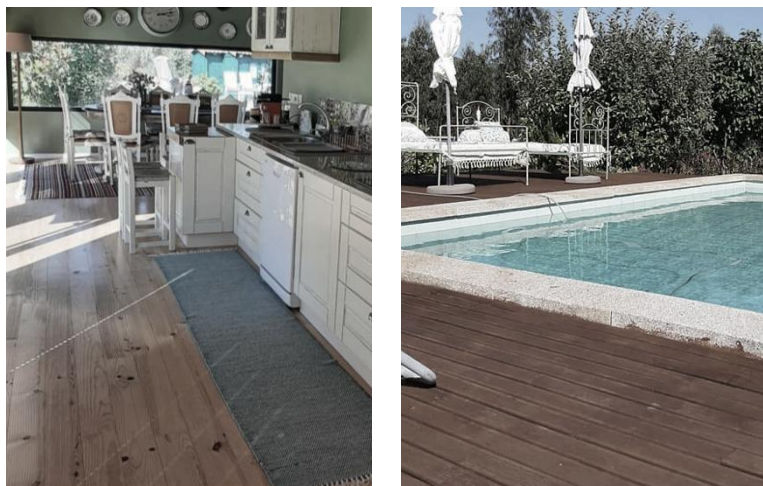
| Pavimento da cozinha revestido em soalho de madeira
